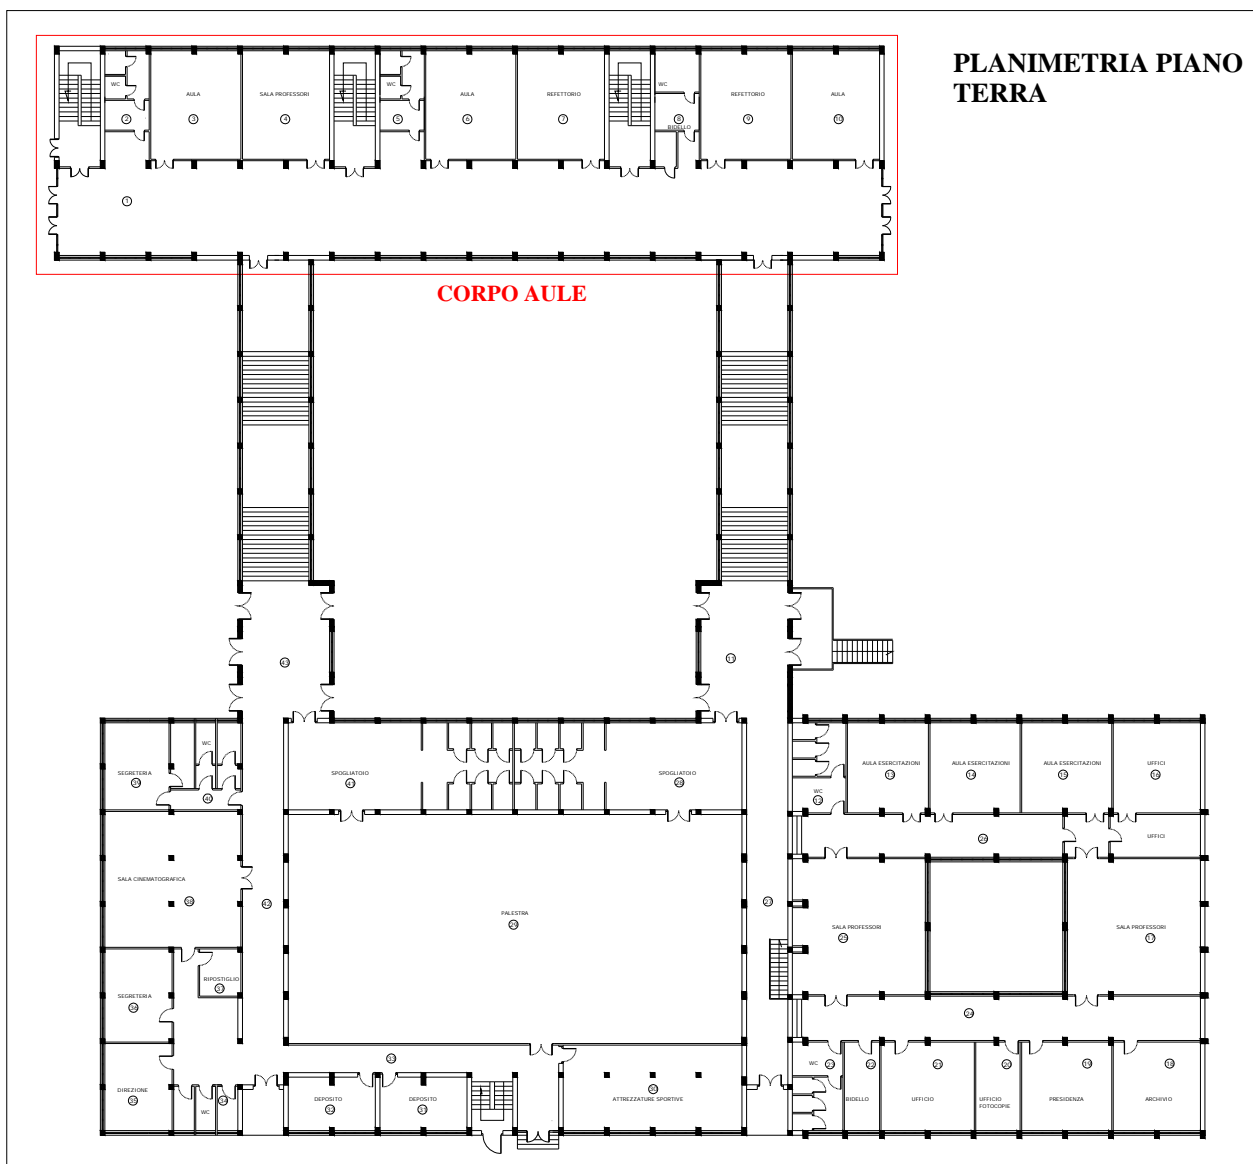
Planimetria del piano terra del plesso scolastico Masi
